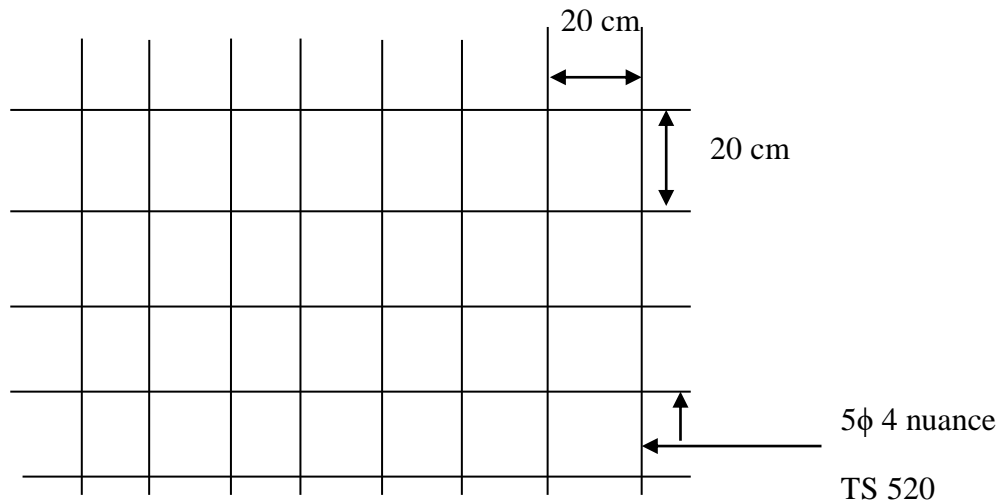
ferrailage de la dalle de compression avec un treillis soudé de 20 x20 cm
